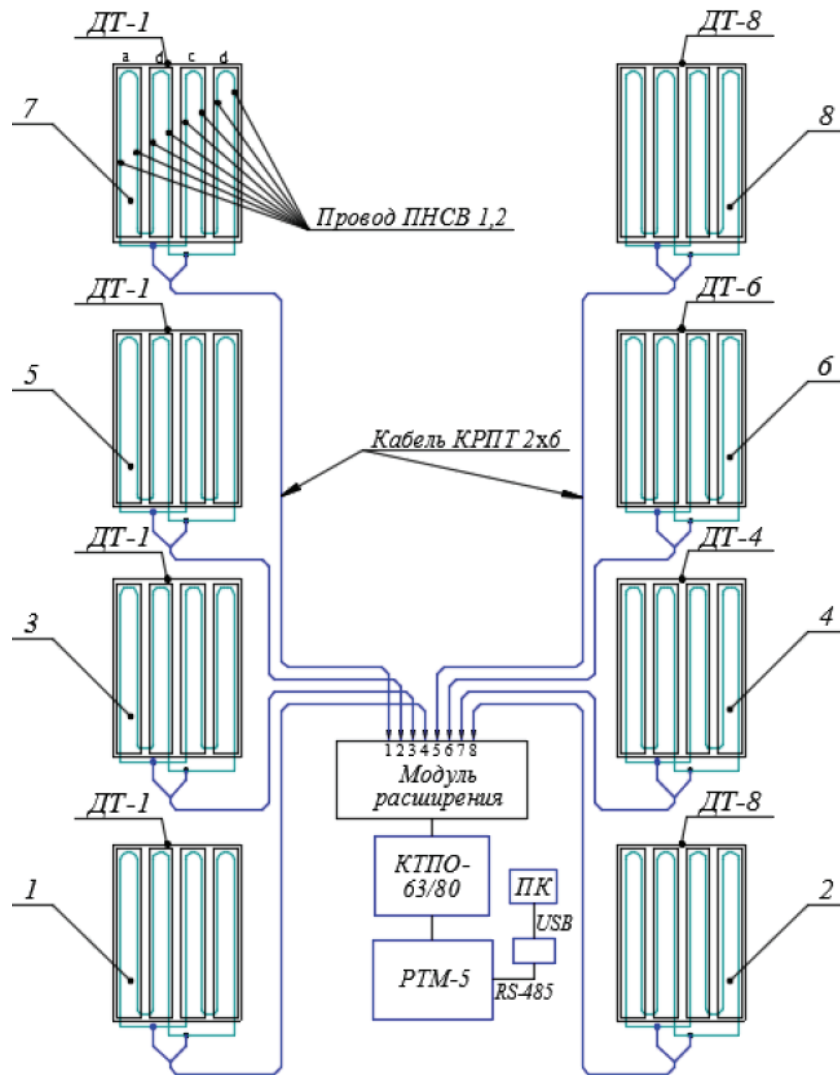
Схема раскладки и подключения нагревательного провода при термообработке бетона.
